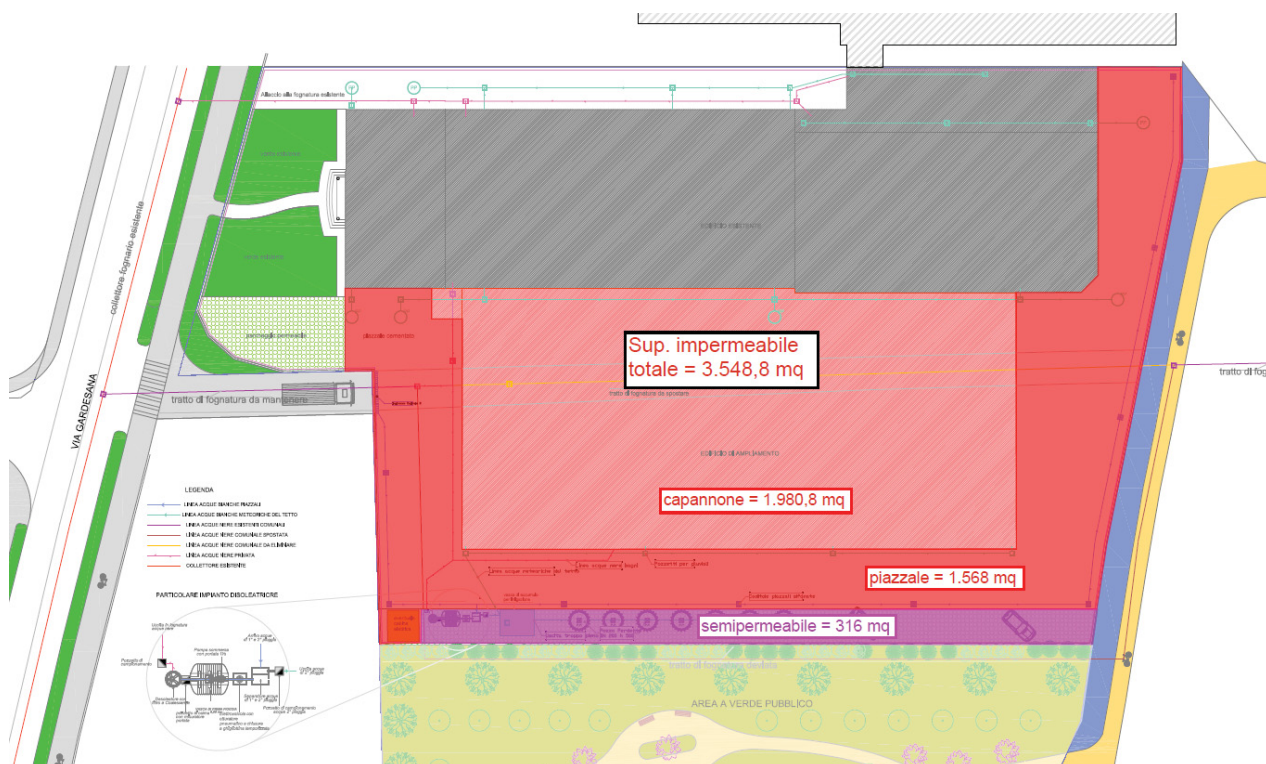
Planimetria di progetto con indicazioni delle superfici impermeabili
